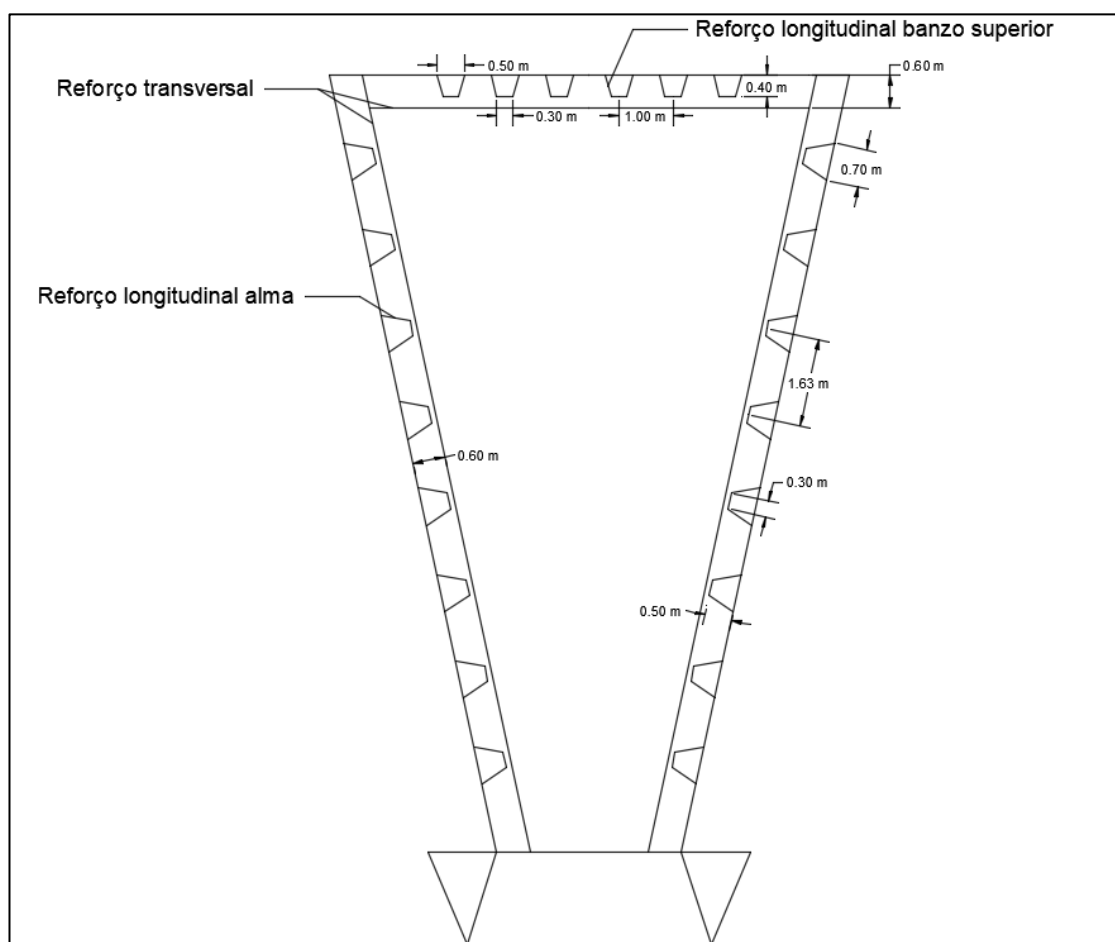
Geometria e disposição dos reforços na secção transversal da viga.
